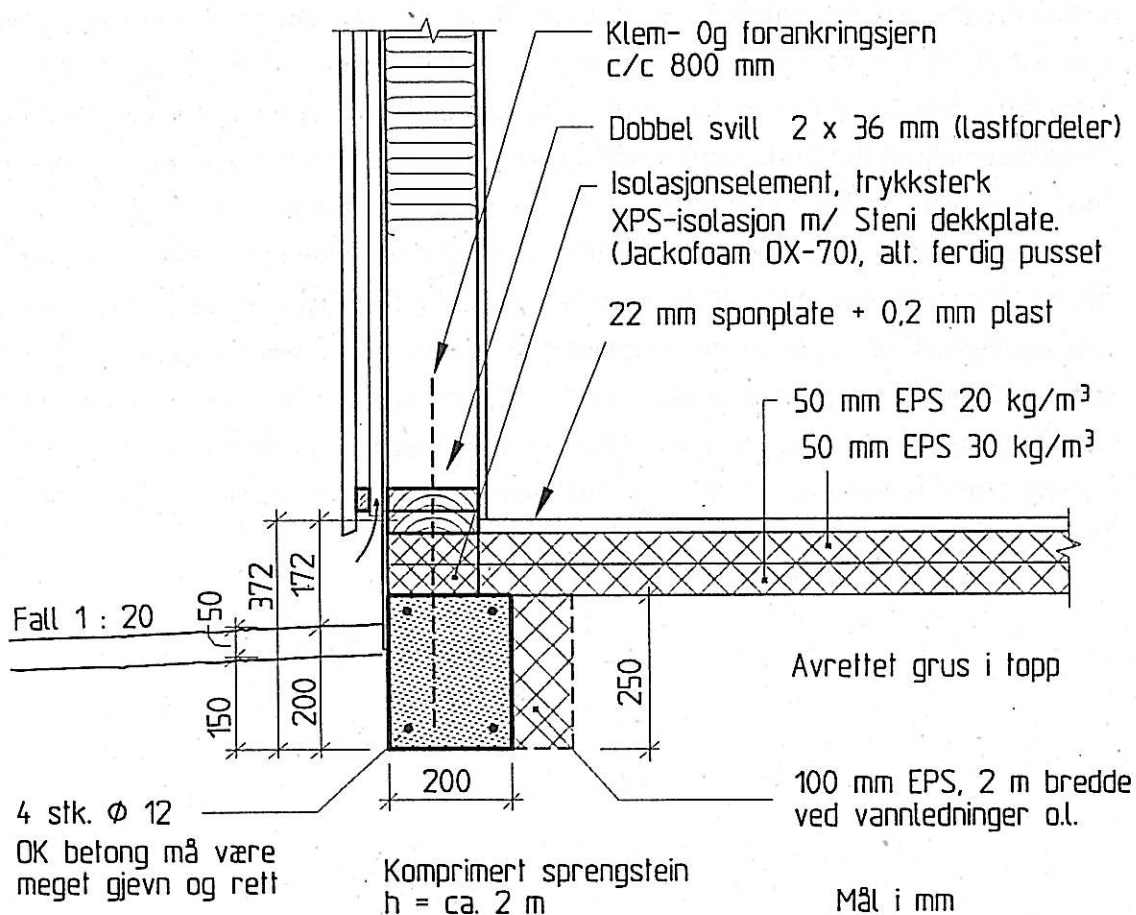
a. Ny gulvkonstruksjon brukt på Heistadtangen
